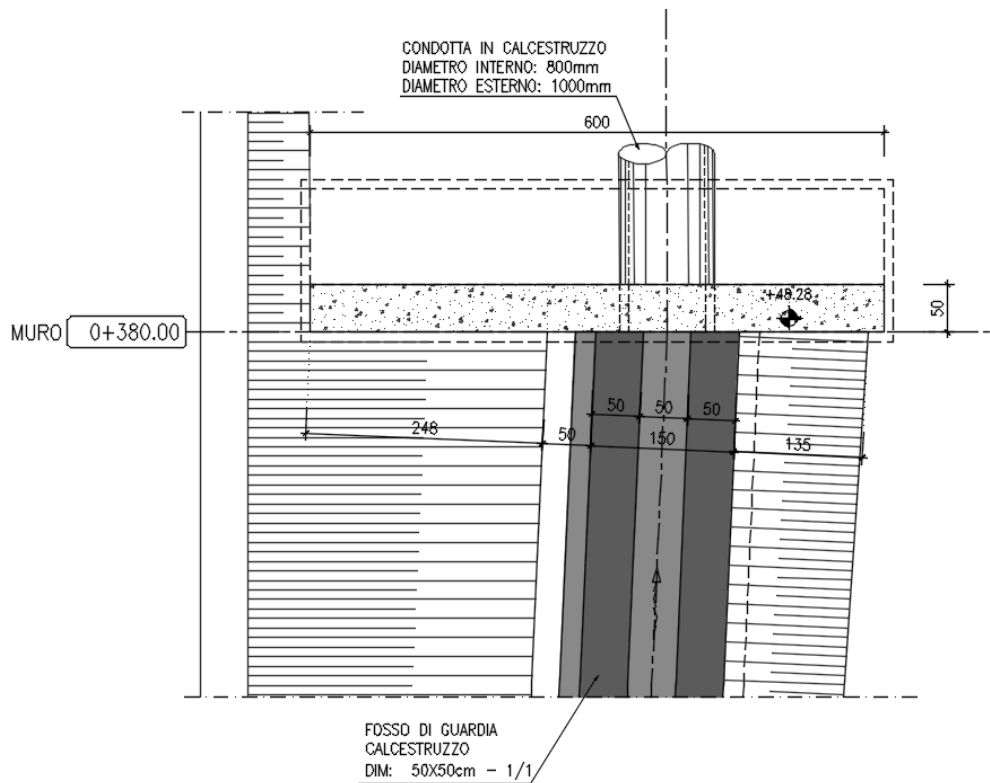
Stralcio planimetrico del muro di connessione idraulica NV54 (pk 0+380.00)
